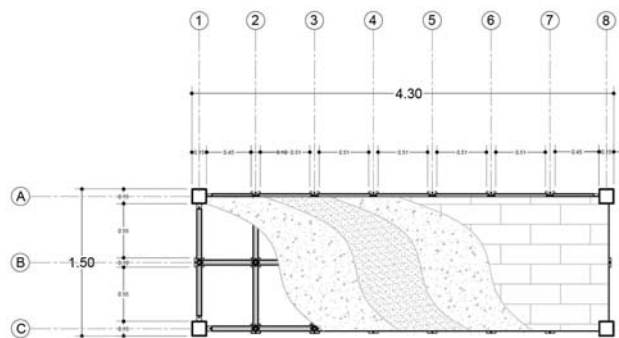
Nelly Hernandez (2018) Planta estructural (plano).
